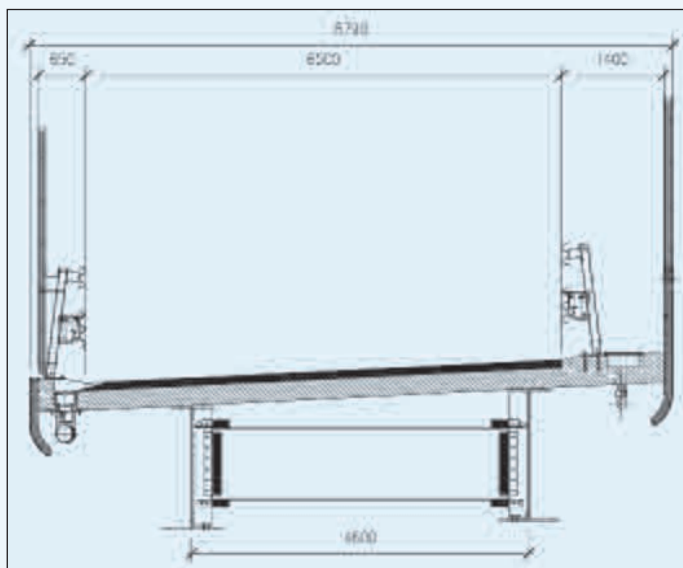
La sezione tipo dei cavalcavia di svincolo
